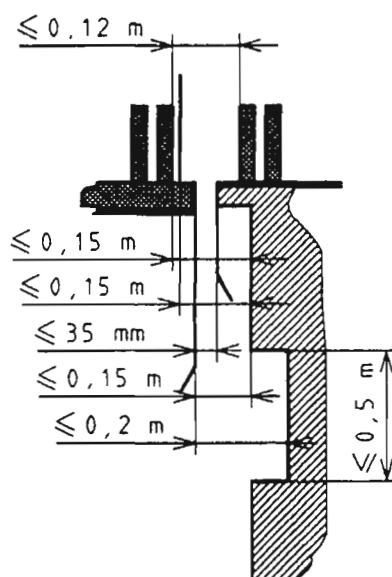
Holguras entre cabina y pared enfrentada a su acceso
